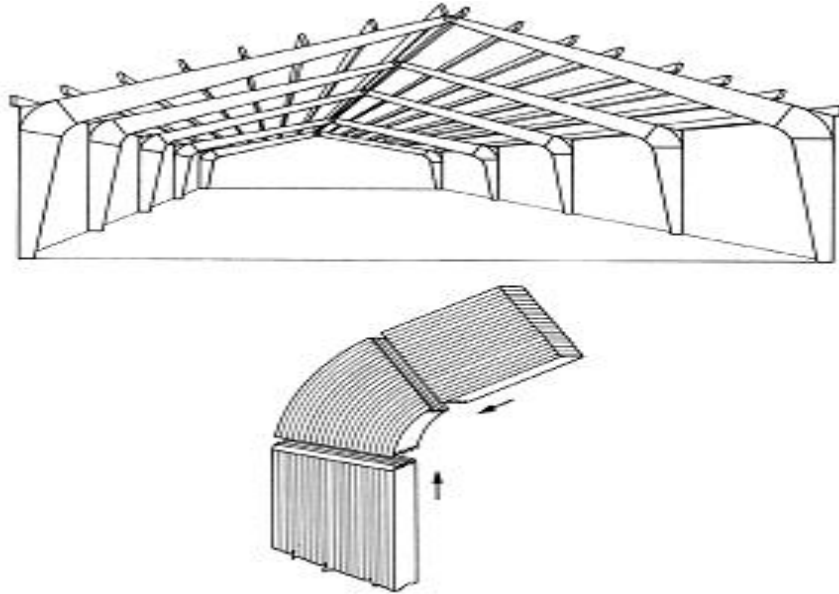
Hall à usages divers : poutres droites (portée de 10 à 25 m) et détail d'assemblage d'angle à entures multiples
